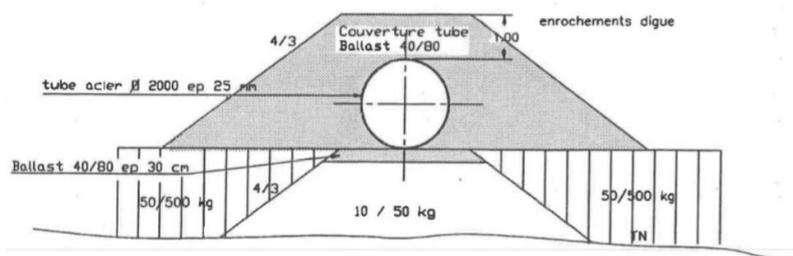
Coupe transversale émissaire sous l'emprise de la digue (source : Plan d'exécution Emissaire sous digue SPADA 1993)
